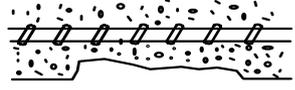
上部構造 (RC・PC 共通) のひび割れ位置およびパターン
